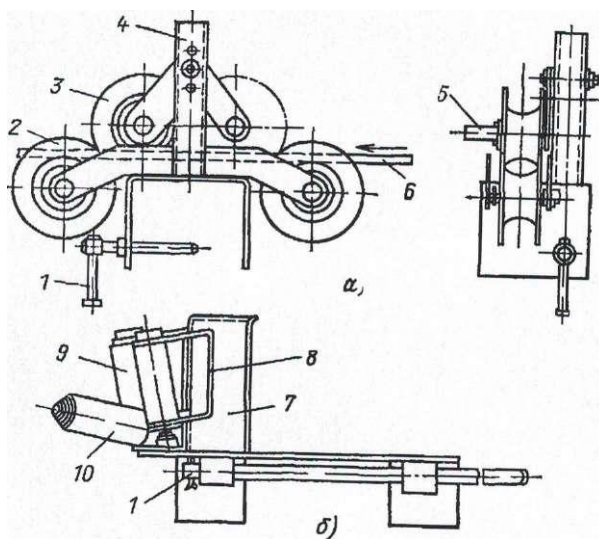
Раскаточные роликовые устройства для проводов ВЛ со штыревыми изоляторами: а — для промежуточных опор; б — для угловых опор ВЛ 10 кВ; 1 — устройство для закрепления на опоре; 2, 3 - нижний и верхний раскаточные ролики; 4 — трубка для надевания устройства на штырь изолятора; 5 — рукоятка верхнего ролика; 6 — раскатываемый провод; 7 — кронштейн; 8 — скобы; 9 — бронзовые ролики; 10 — ролики, на которые укладывается раскатываемый провод.
